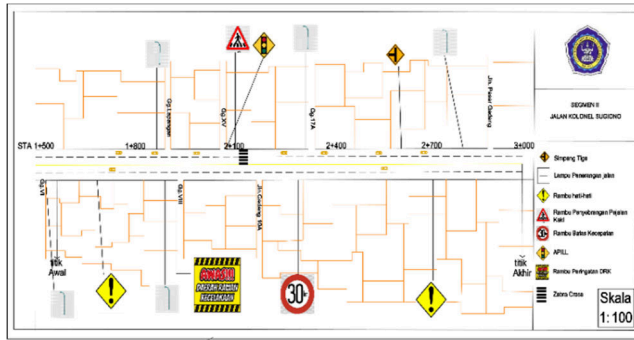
Layout for improving road safety on segment II of Kolonel Sugiono Street
